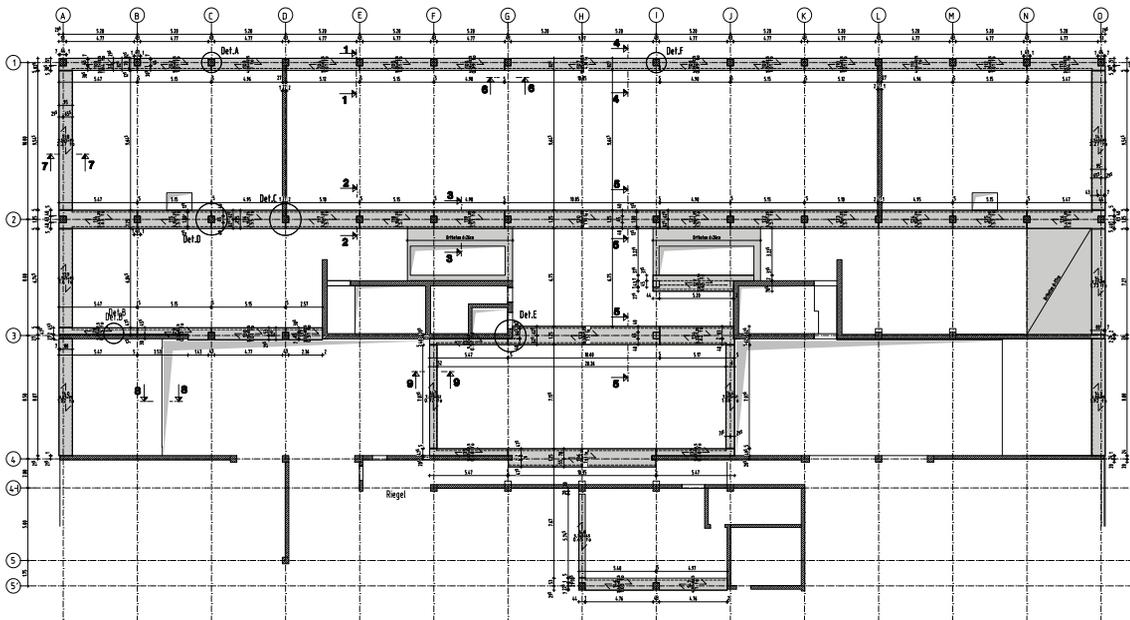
Verlegeplan Unterzüge Ebene 0\_-1
